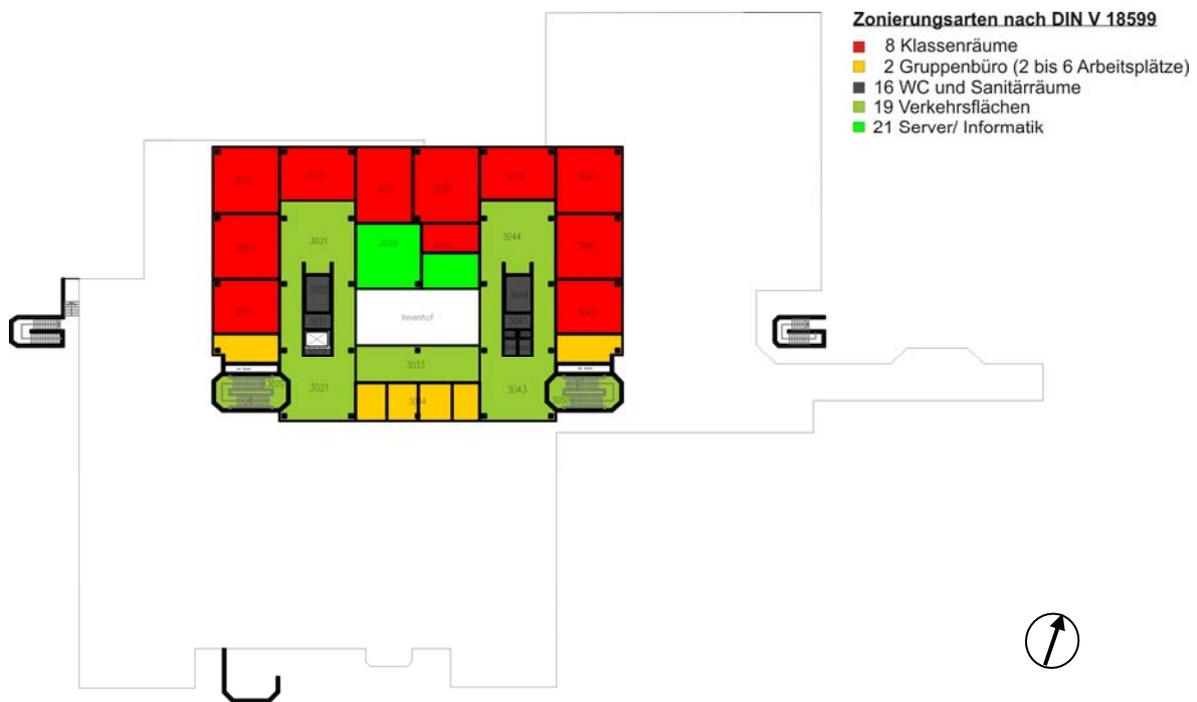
Haupt- und Realschule Grundriss 1.OG Planung
